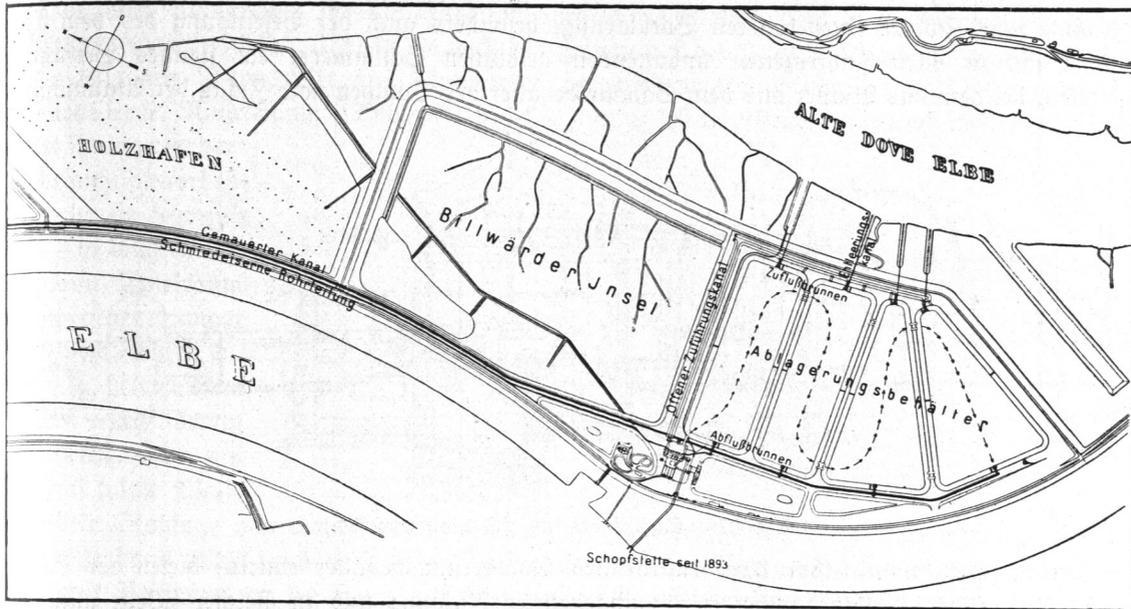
Elbwasserschöpfwerk, Lageplan.
